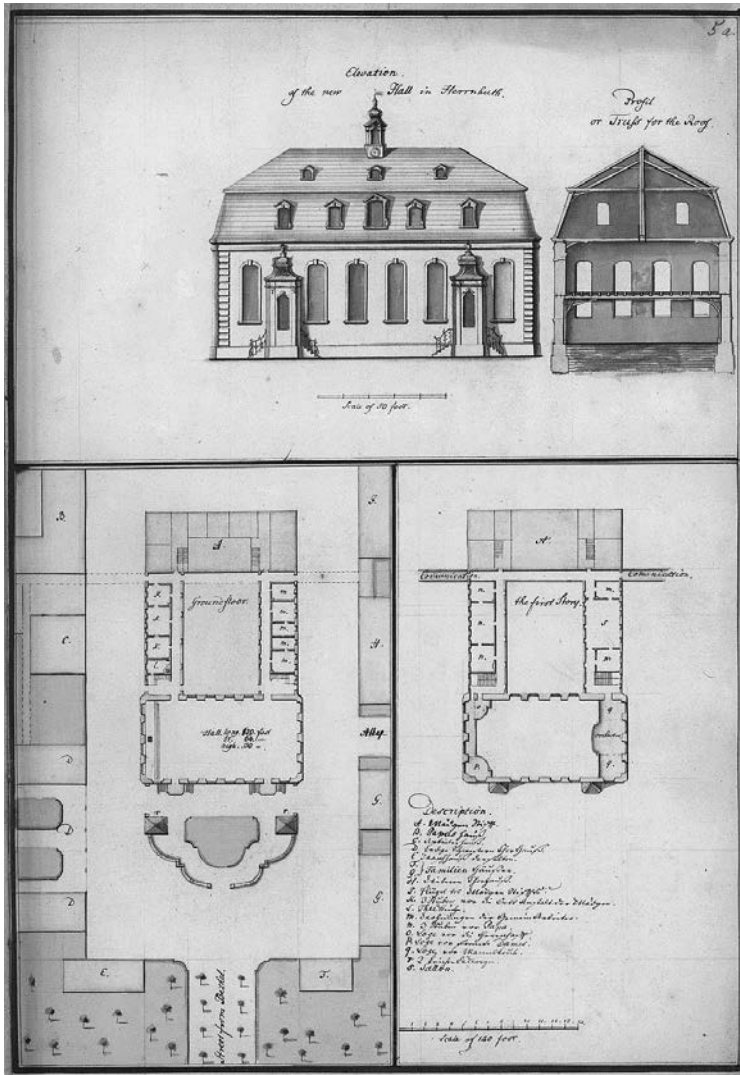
Entwurf zum Bau eines Kirchensaales für Herrnhut, Lageplan mit Grundriss, Grundriss erste Etage, Ansicht der Fassade und Schnitt, 1755 (UA, TS Bd. 3.5.a) Verfasser des Entwurfs war Siegmund August von Gersdorf. Die Zeichnung zeigt eine Längsausrichtung des Saales mit der Stellung des Liturgisches an der südlichen Schmalseite des Raumes. Der Kirchenraum schließt sich damit an die allgemeinen evangelischen Kirchenbautraditionen an, was durch die Anerkennung der Brüdergemeinde durch das kurfürstliche Versicherungsedikt vom 20. September 1749 und die Lösung Herrnhuts aus dem Parochialverbund mit Berthelsdorf 1756 gerechtfertigt schien.
